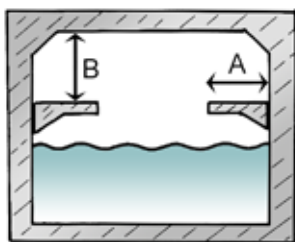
Voorbeeld van een tunnel met twee hoogteniveaus zonder specifieke functie voor fauna waarbij in niet aangepaste vorm reeds sprake is van gebruik door dieren.
